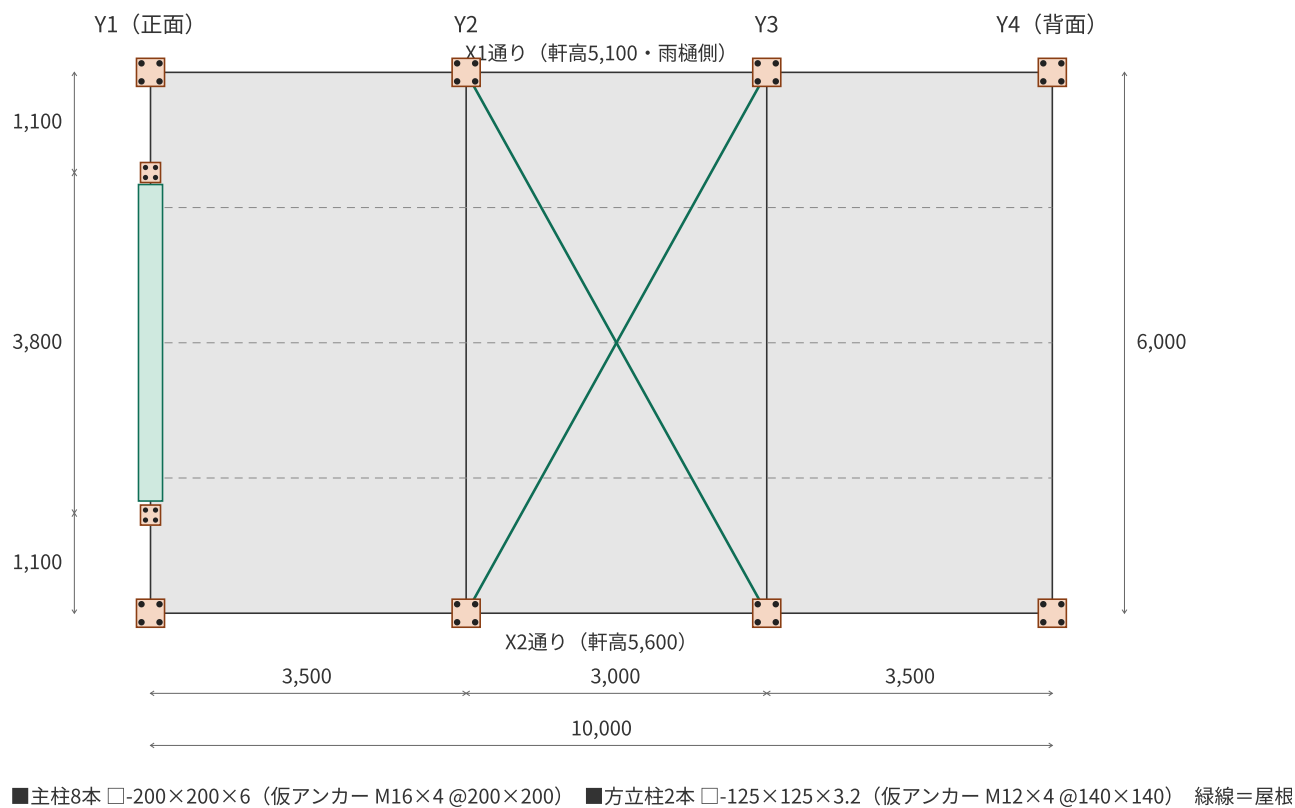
平面図 $s=1:100$ 柱型（600角）はすべての柱に設ける。アンカーボルトは建方時の仮固定用で、本設の固定は柱型コンクリートによる（4-5参照）
